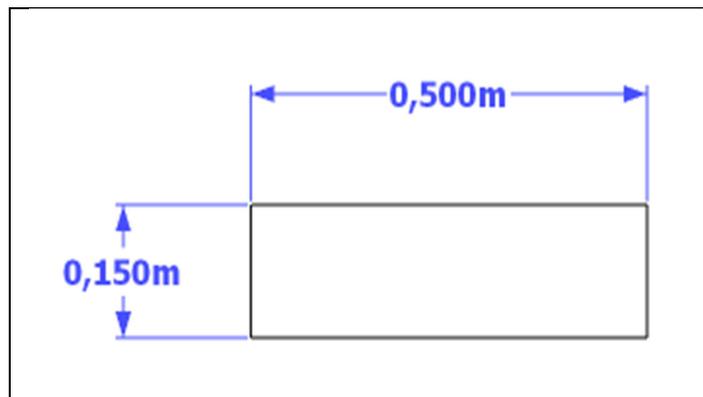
Vista de planta de un banco de concreto para la colocación de uno de los extremos de la columna semi-terminada.
